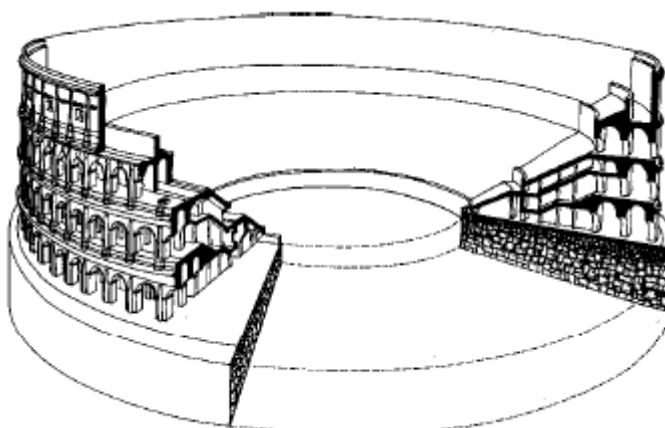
Coliseu de Roma, Itália (ilustração das fundações e superestrutura)
